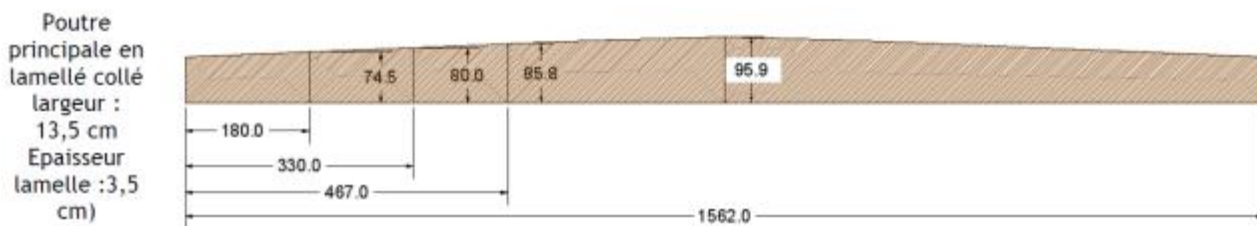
Caractéristiques des poutres principales (poutres 2) de plus petite portée
